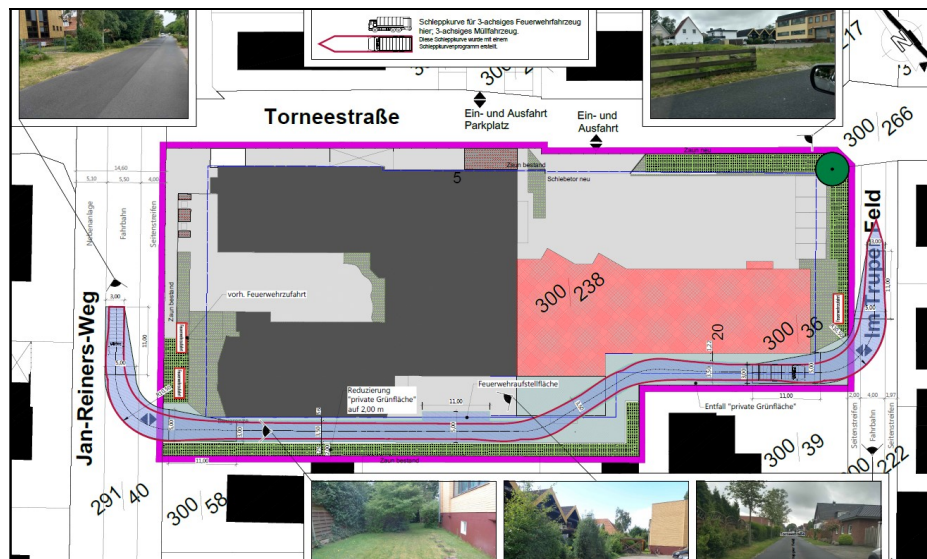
Lageplan zur Feuerwehrumfahrung (Fahrspur gemäß DIN 14090). Die im Osten skizzierten Stellplätze werden nicht umgesetzt, da sich die erforderliche Anzahl an Einstellplätzen gemäß § 47 NBauO bereits nördlich des Geltungsbereiches befindet (Quelle: Umtec, Bremen, Stand: 30.07.2019). Karte verdeutlicht nur die Feuerwehrumfahrung. Aktuelle Hallengröße sowie aktueller Ein- und Ausfahrtsbereich sind der nachfolgenden Abbildung 6 zu entnehmen.
